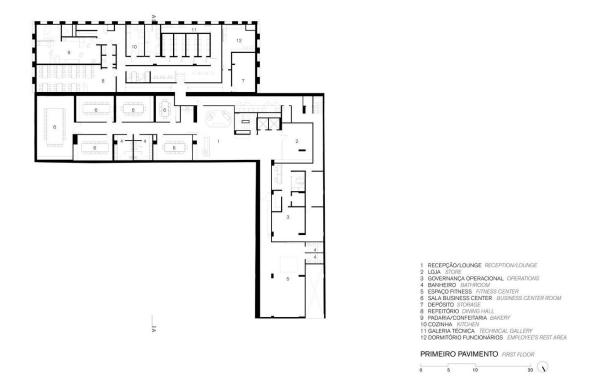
Planta baixa do segundo pavimento do Hotel Fasano
